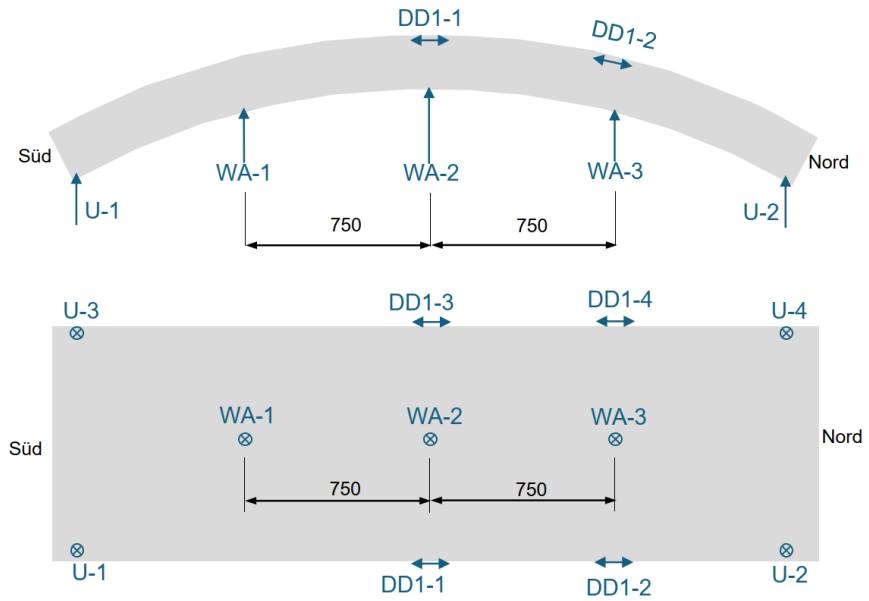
Messanordnung im Grundriss: Verformungsmessungen an Lehmkappendecke
